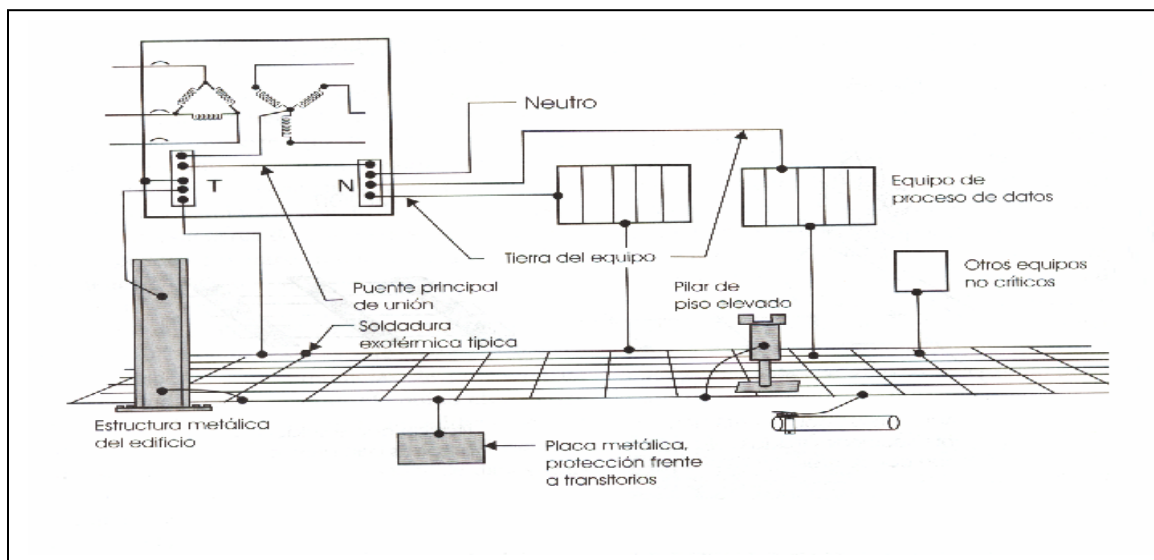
El piso elevado forma un plano equipotencial.
